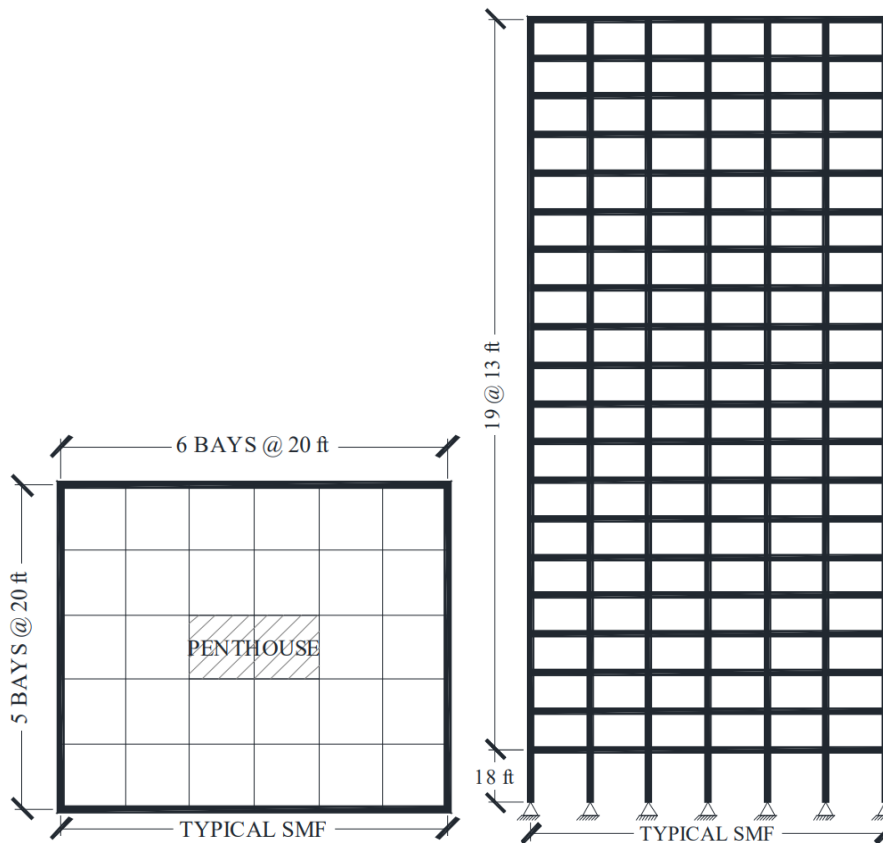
Vista en planta y transversal del edificio de 20 pisos en estudio (Wood 2012).
